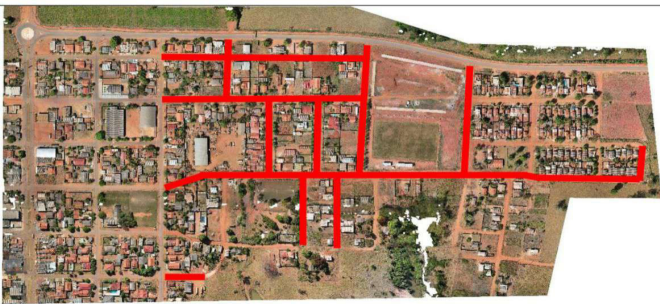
LOCAL DA PAVIMENTAÇÃO.
